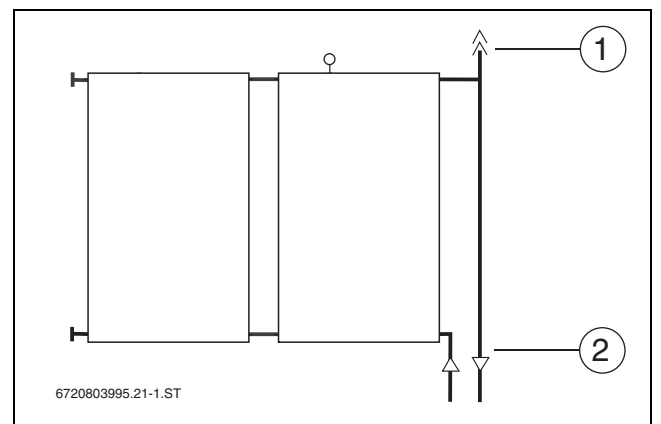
Przeprowadzenie przewodu rurowego (zasilanie) przez dach
